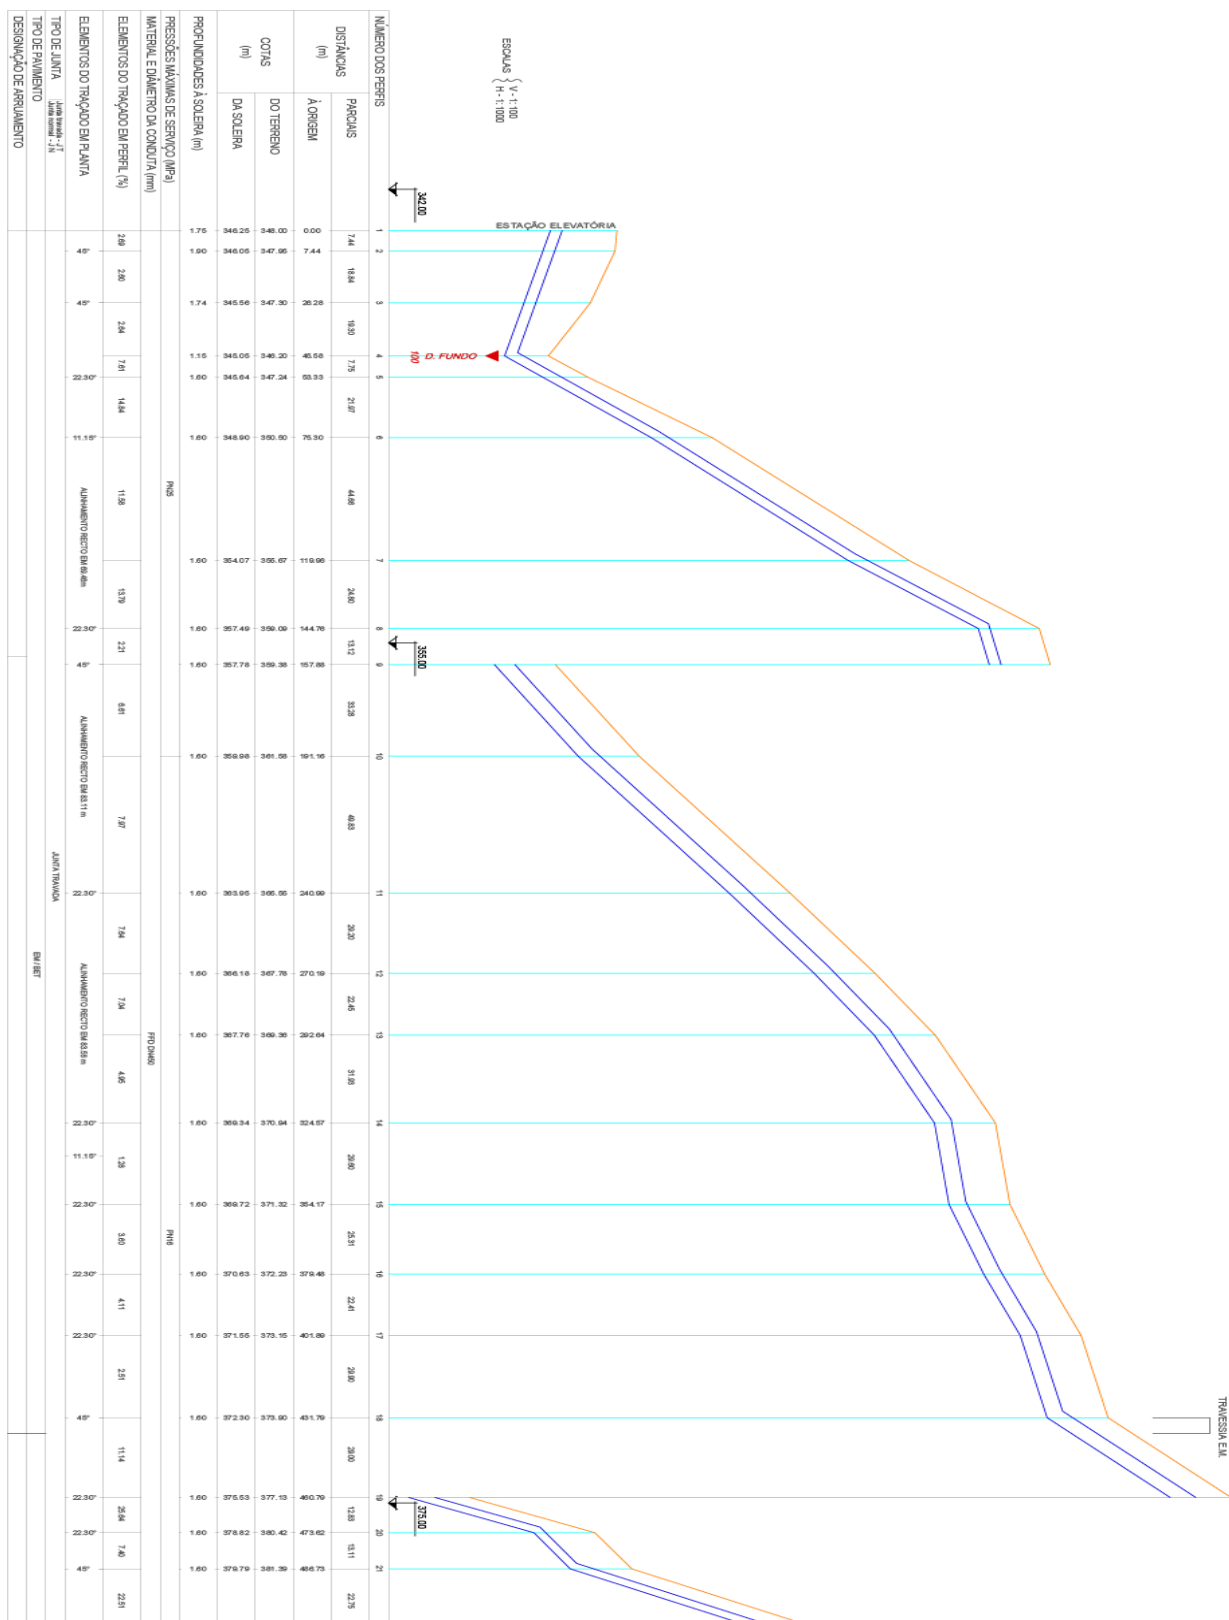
Exemplo do traçado do perfil de uma conduta³
